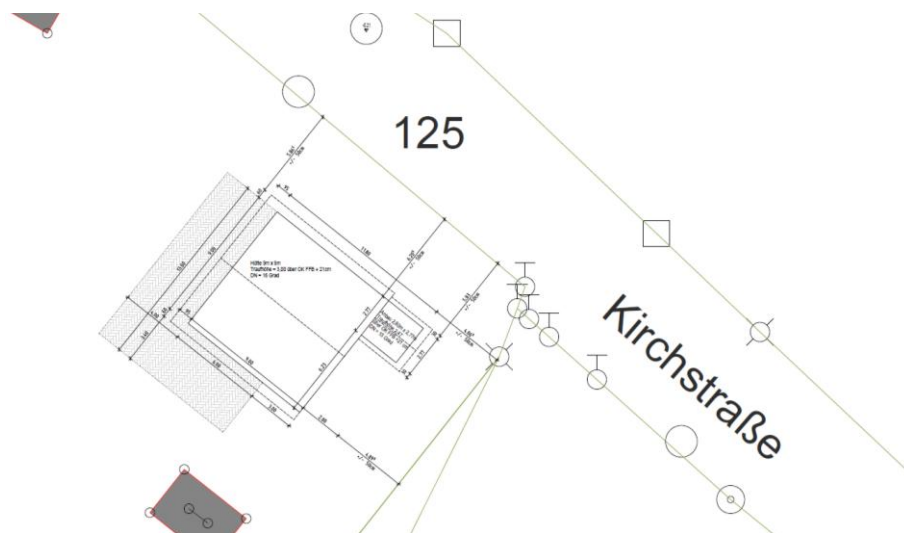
Lageplan, ohne Maßstab. Quelle: Schmid Kunstholzbau (Stand 15.02.2022)
